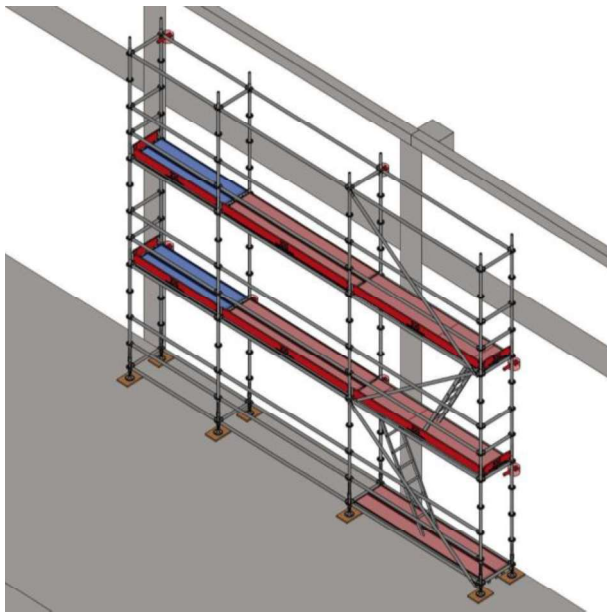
Ilustração de andaime fachadeiro do tipo modular
